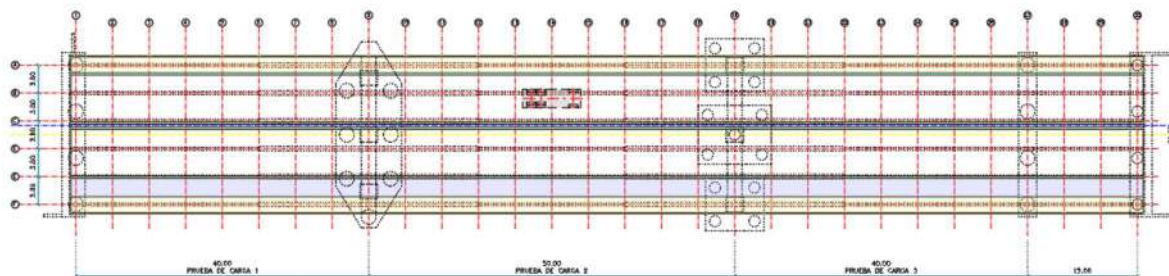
Posicionamiento de cargas, Prueba 2 – 1Camión (P2C1).
